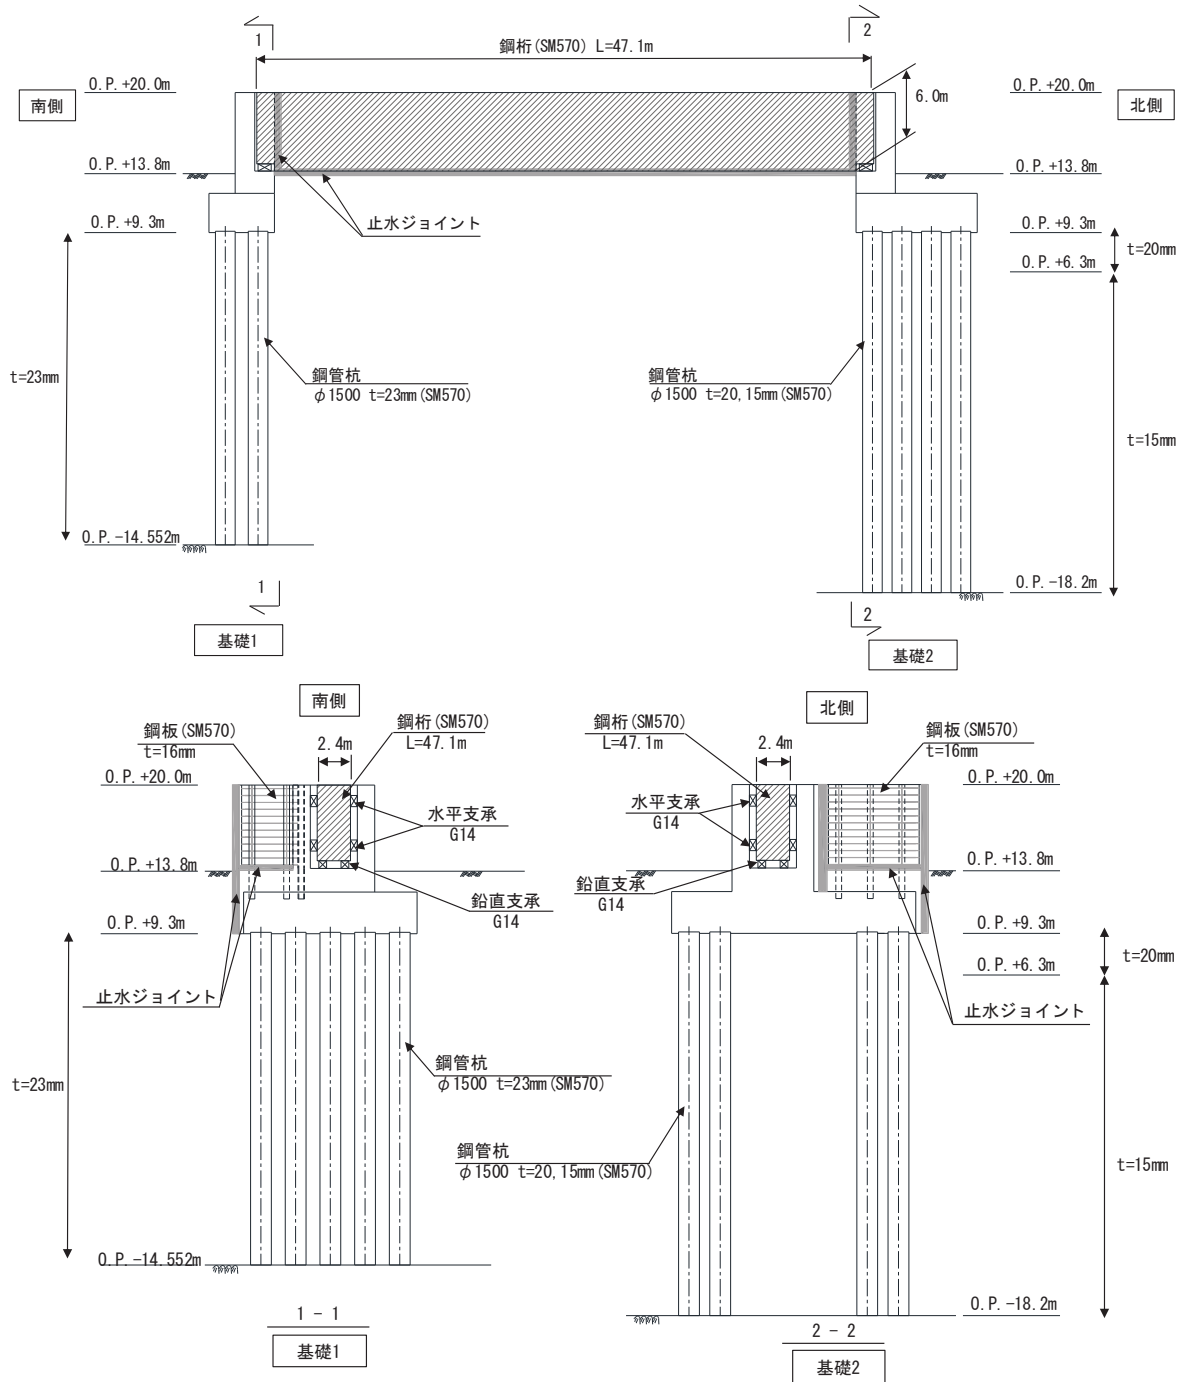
鋼製遮水壁 (鋼桁 4) 正面図及び断面図
